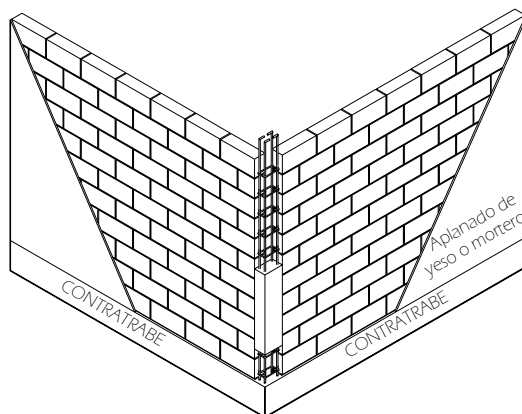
Muros de mampostería de bloques o ladrillos. (Fuente propia).
